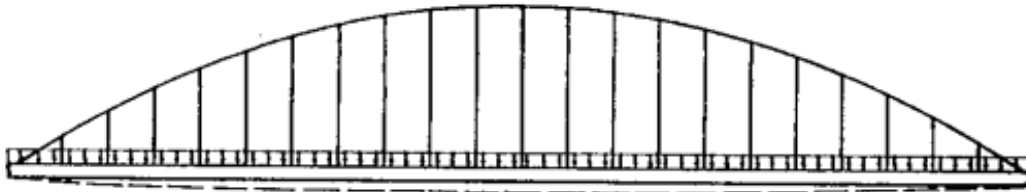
Zonas a compresión y tracción en un puente en arco atirantado.
